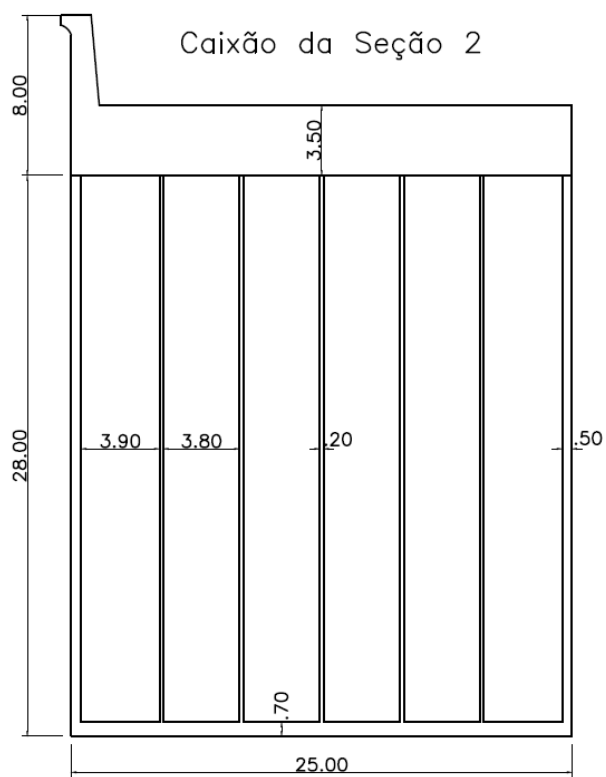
Caixão pré-dimensionado da seção 2. Dimensões em m.
